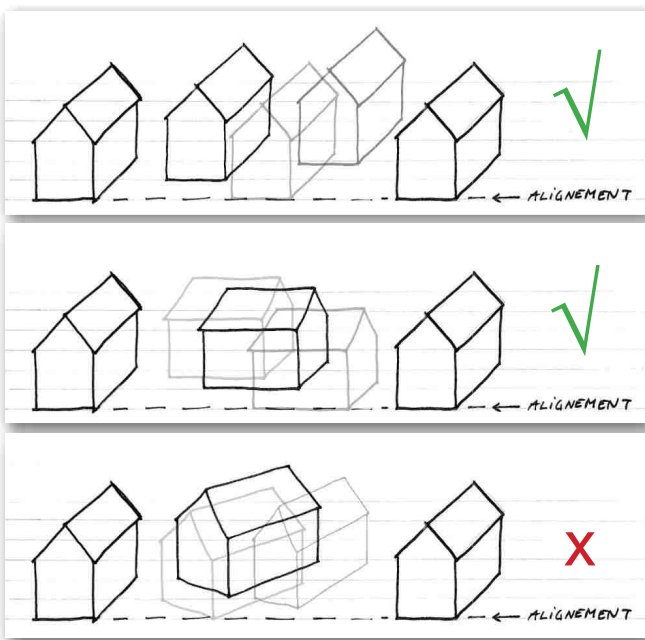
/ Implantation d'une nouvelle construction en fonction des faitages des constructions existantes: parallèle, perpendiculaire ou oblique.
